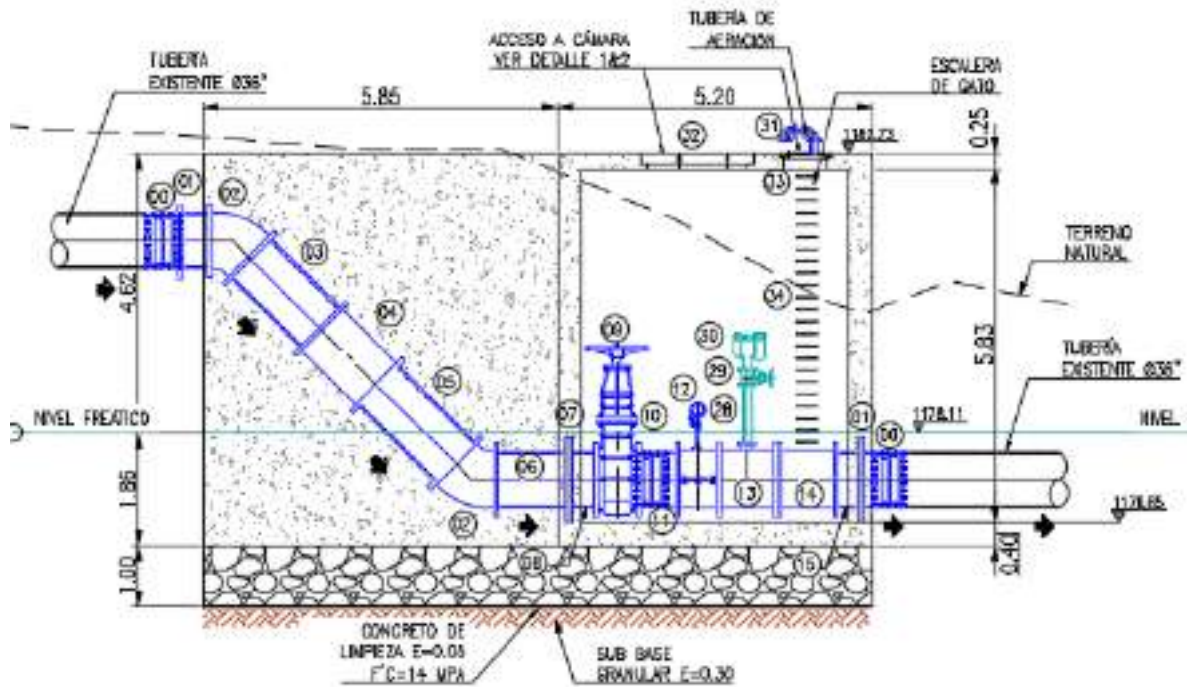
Vista en planta de la caja de mariposa 36"
